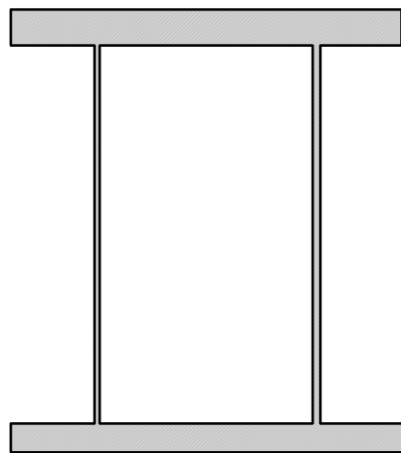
Побудова стін і перегородок фрагмента будівлі
